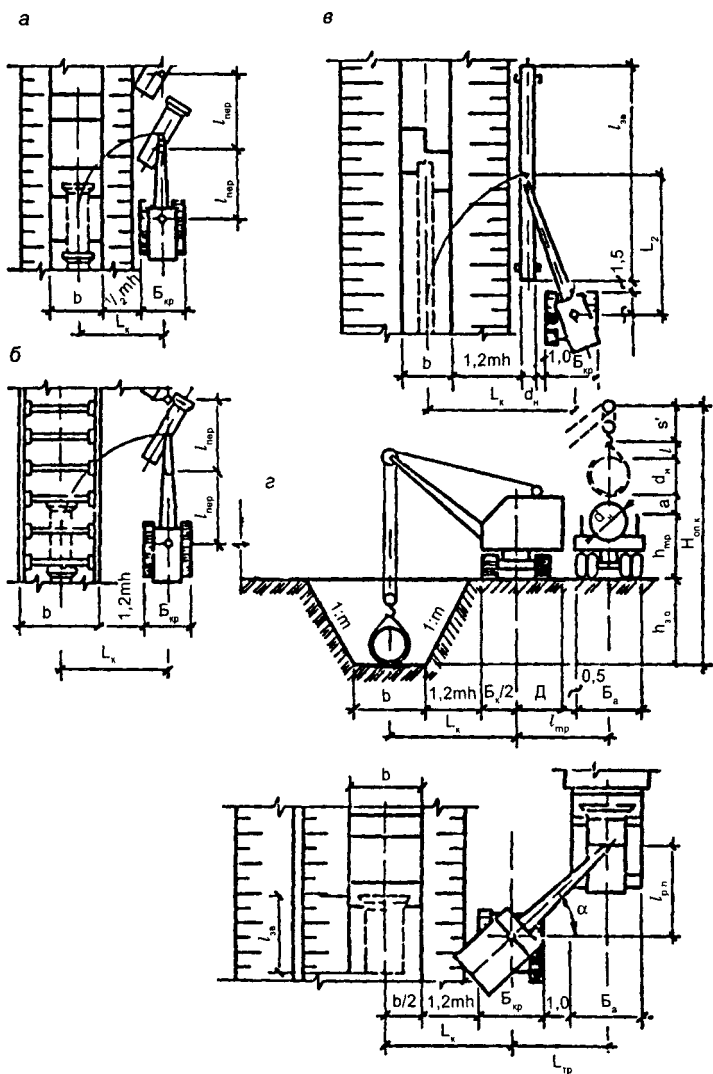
Схема определения рабочих параметров крана при прокладке труб:
